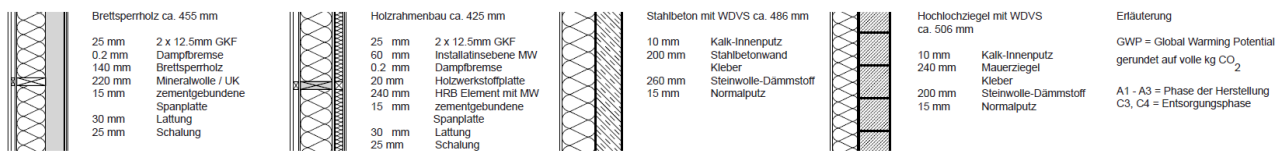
/ Vergleich der CO<sub>2</sub>-Emissionwerte beispielhafter Außenwandkonstruktionen (siehe Anlage [BLF C.1.2.1 Mehrgeschossiger Holzbau GRUNDLAGE HZ3.pdf](#))
